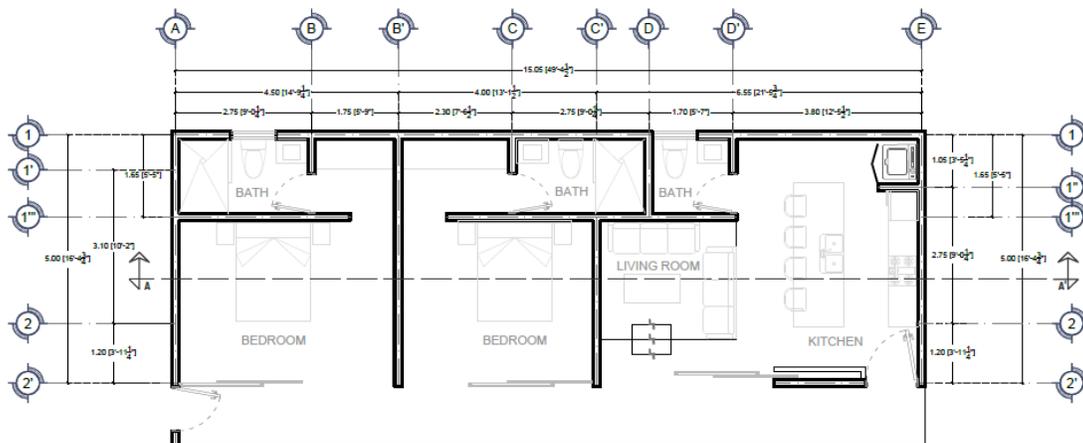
Planta arquitectónica del departamento tipo del Edificio 1.
